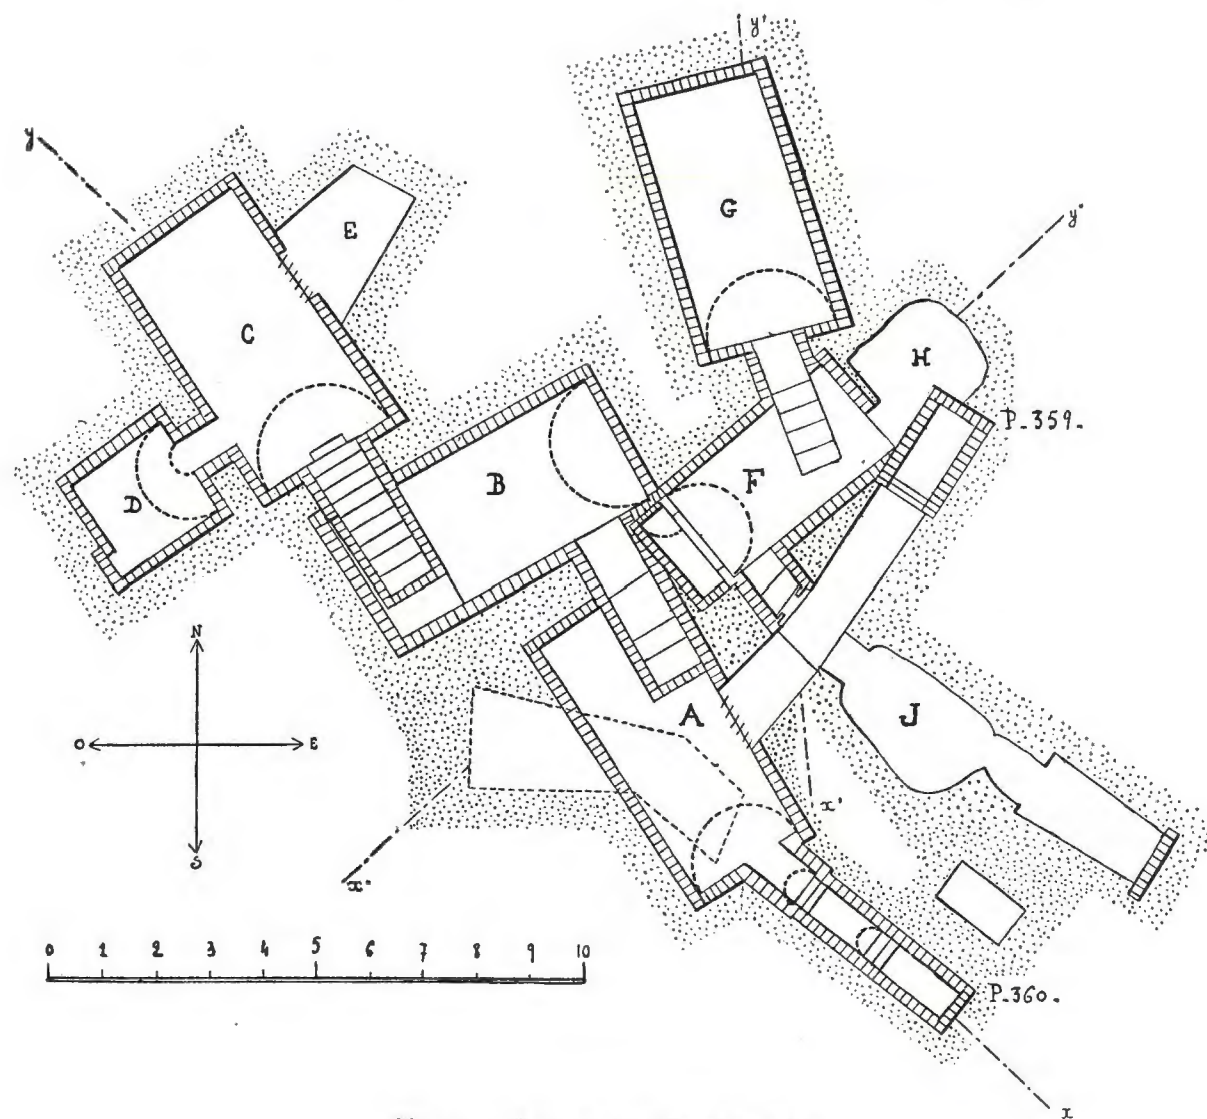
PLANS DES CAVEAUX N° 359 ET 360.
